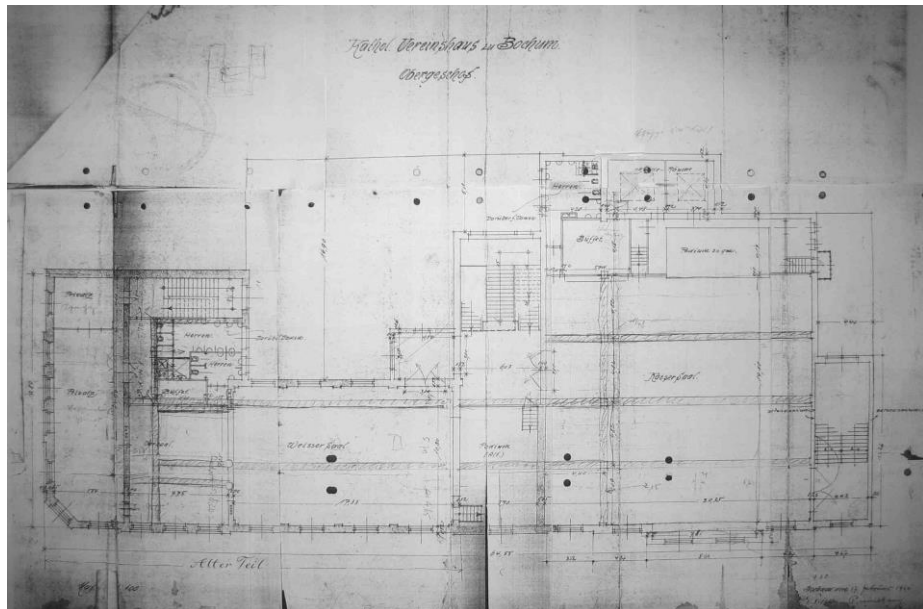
Grundriss Obergeschoss, 17.02.1910 [AGvBO, Sammlung]
